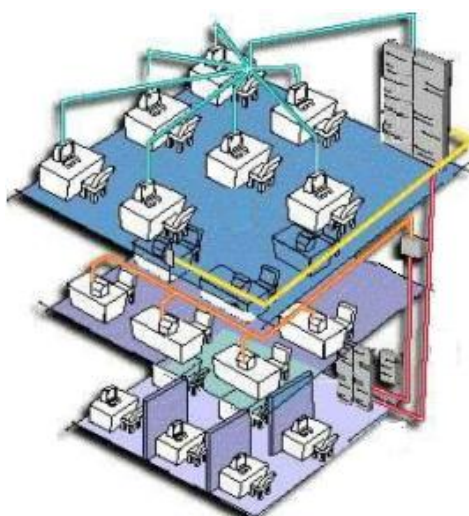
Sistema de Cableado Estructurado²⁹
